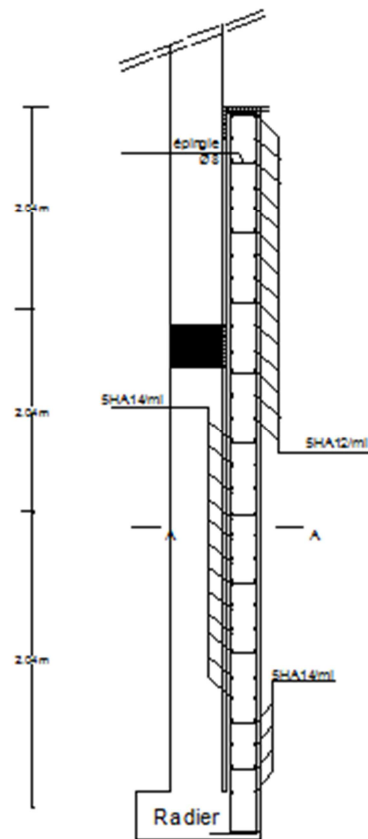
Schéma statique du ferrailage du mur plaque
